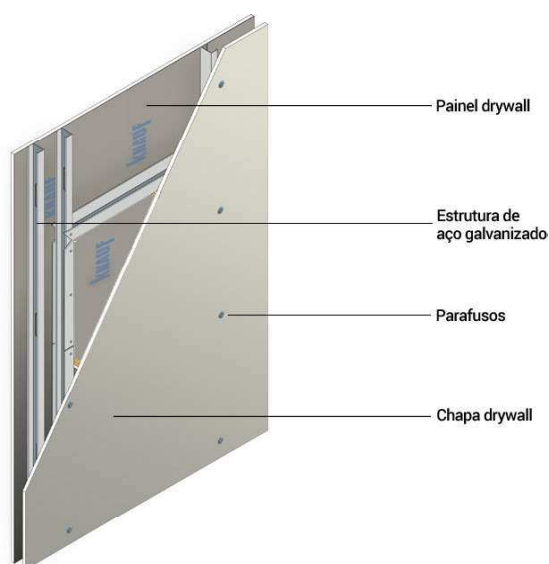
Esquema de Drywall. Fonte: Sulmodulos, 2024.
